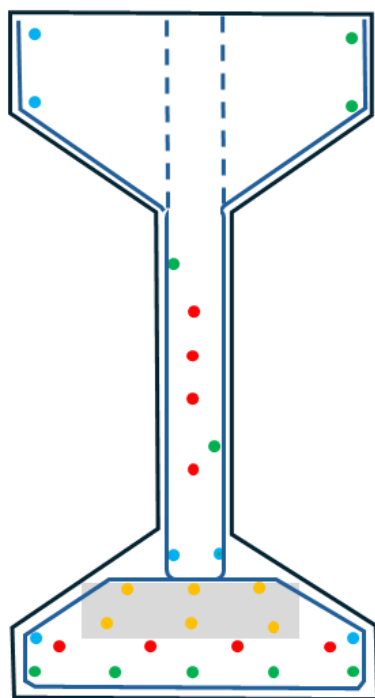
Coupe schématique du principe de ferrailage des poutres en about
